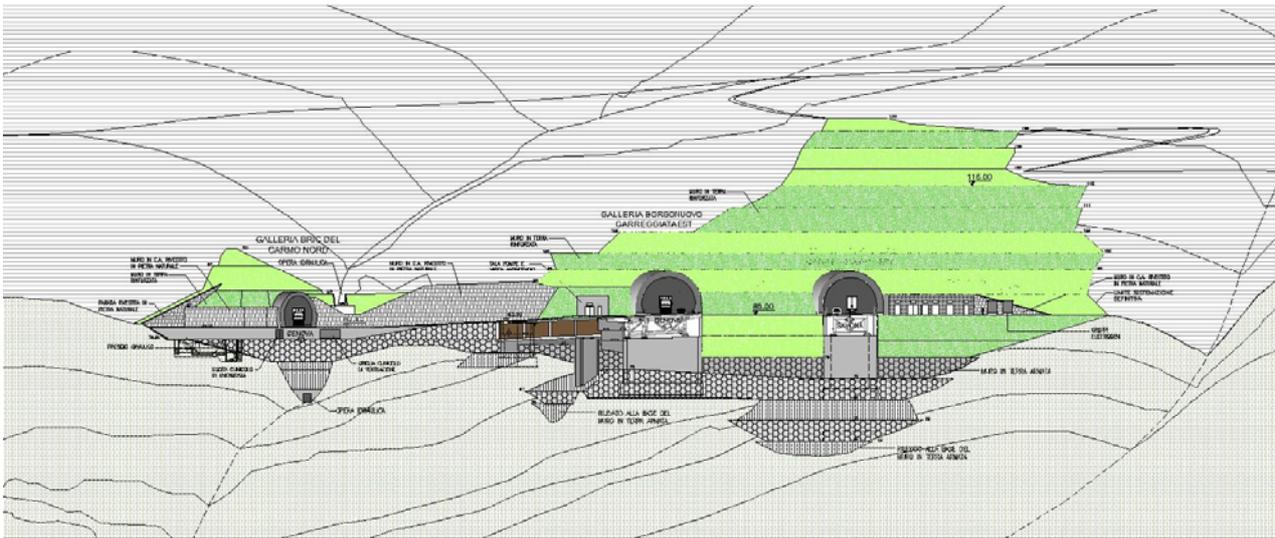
Prospetto dell'area di imbocco (cfr. AUA0106-2)
